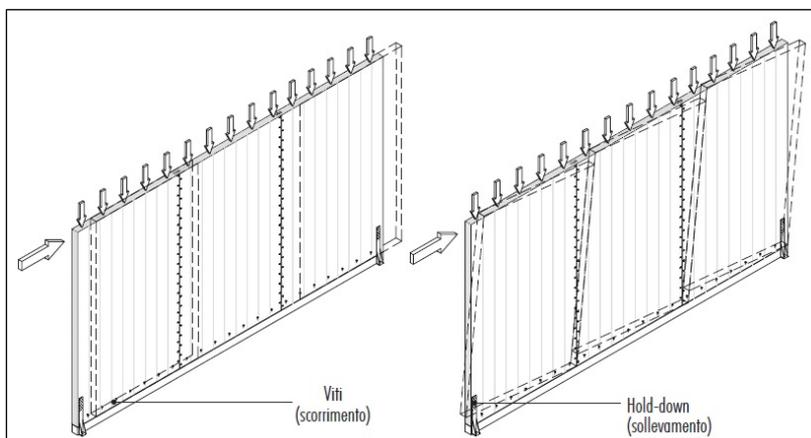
Parete XLAM soggetta ad azioni orizzontali nel piano.
